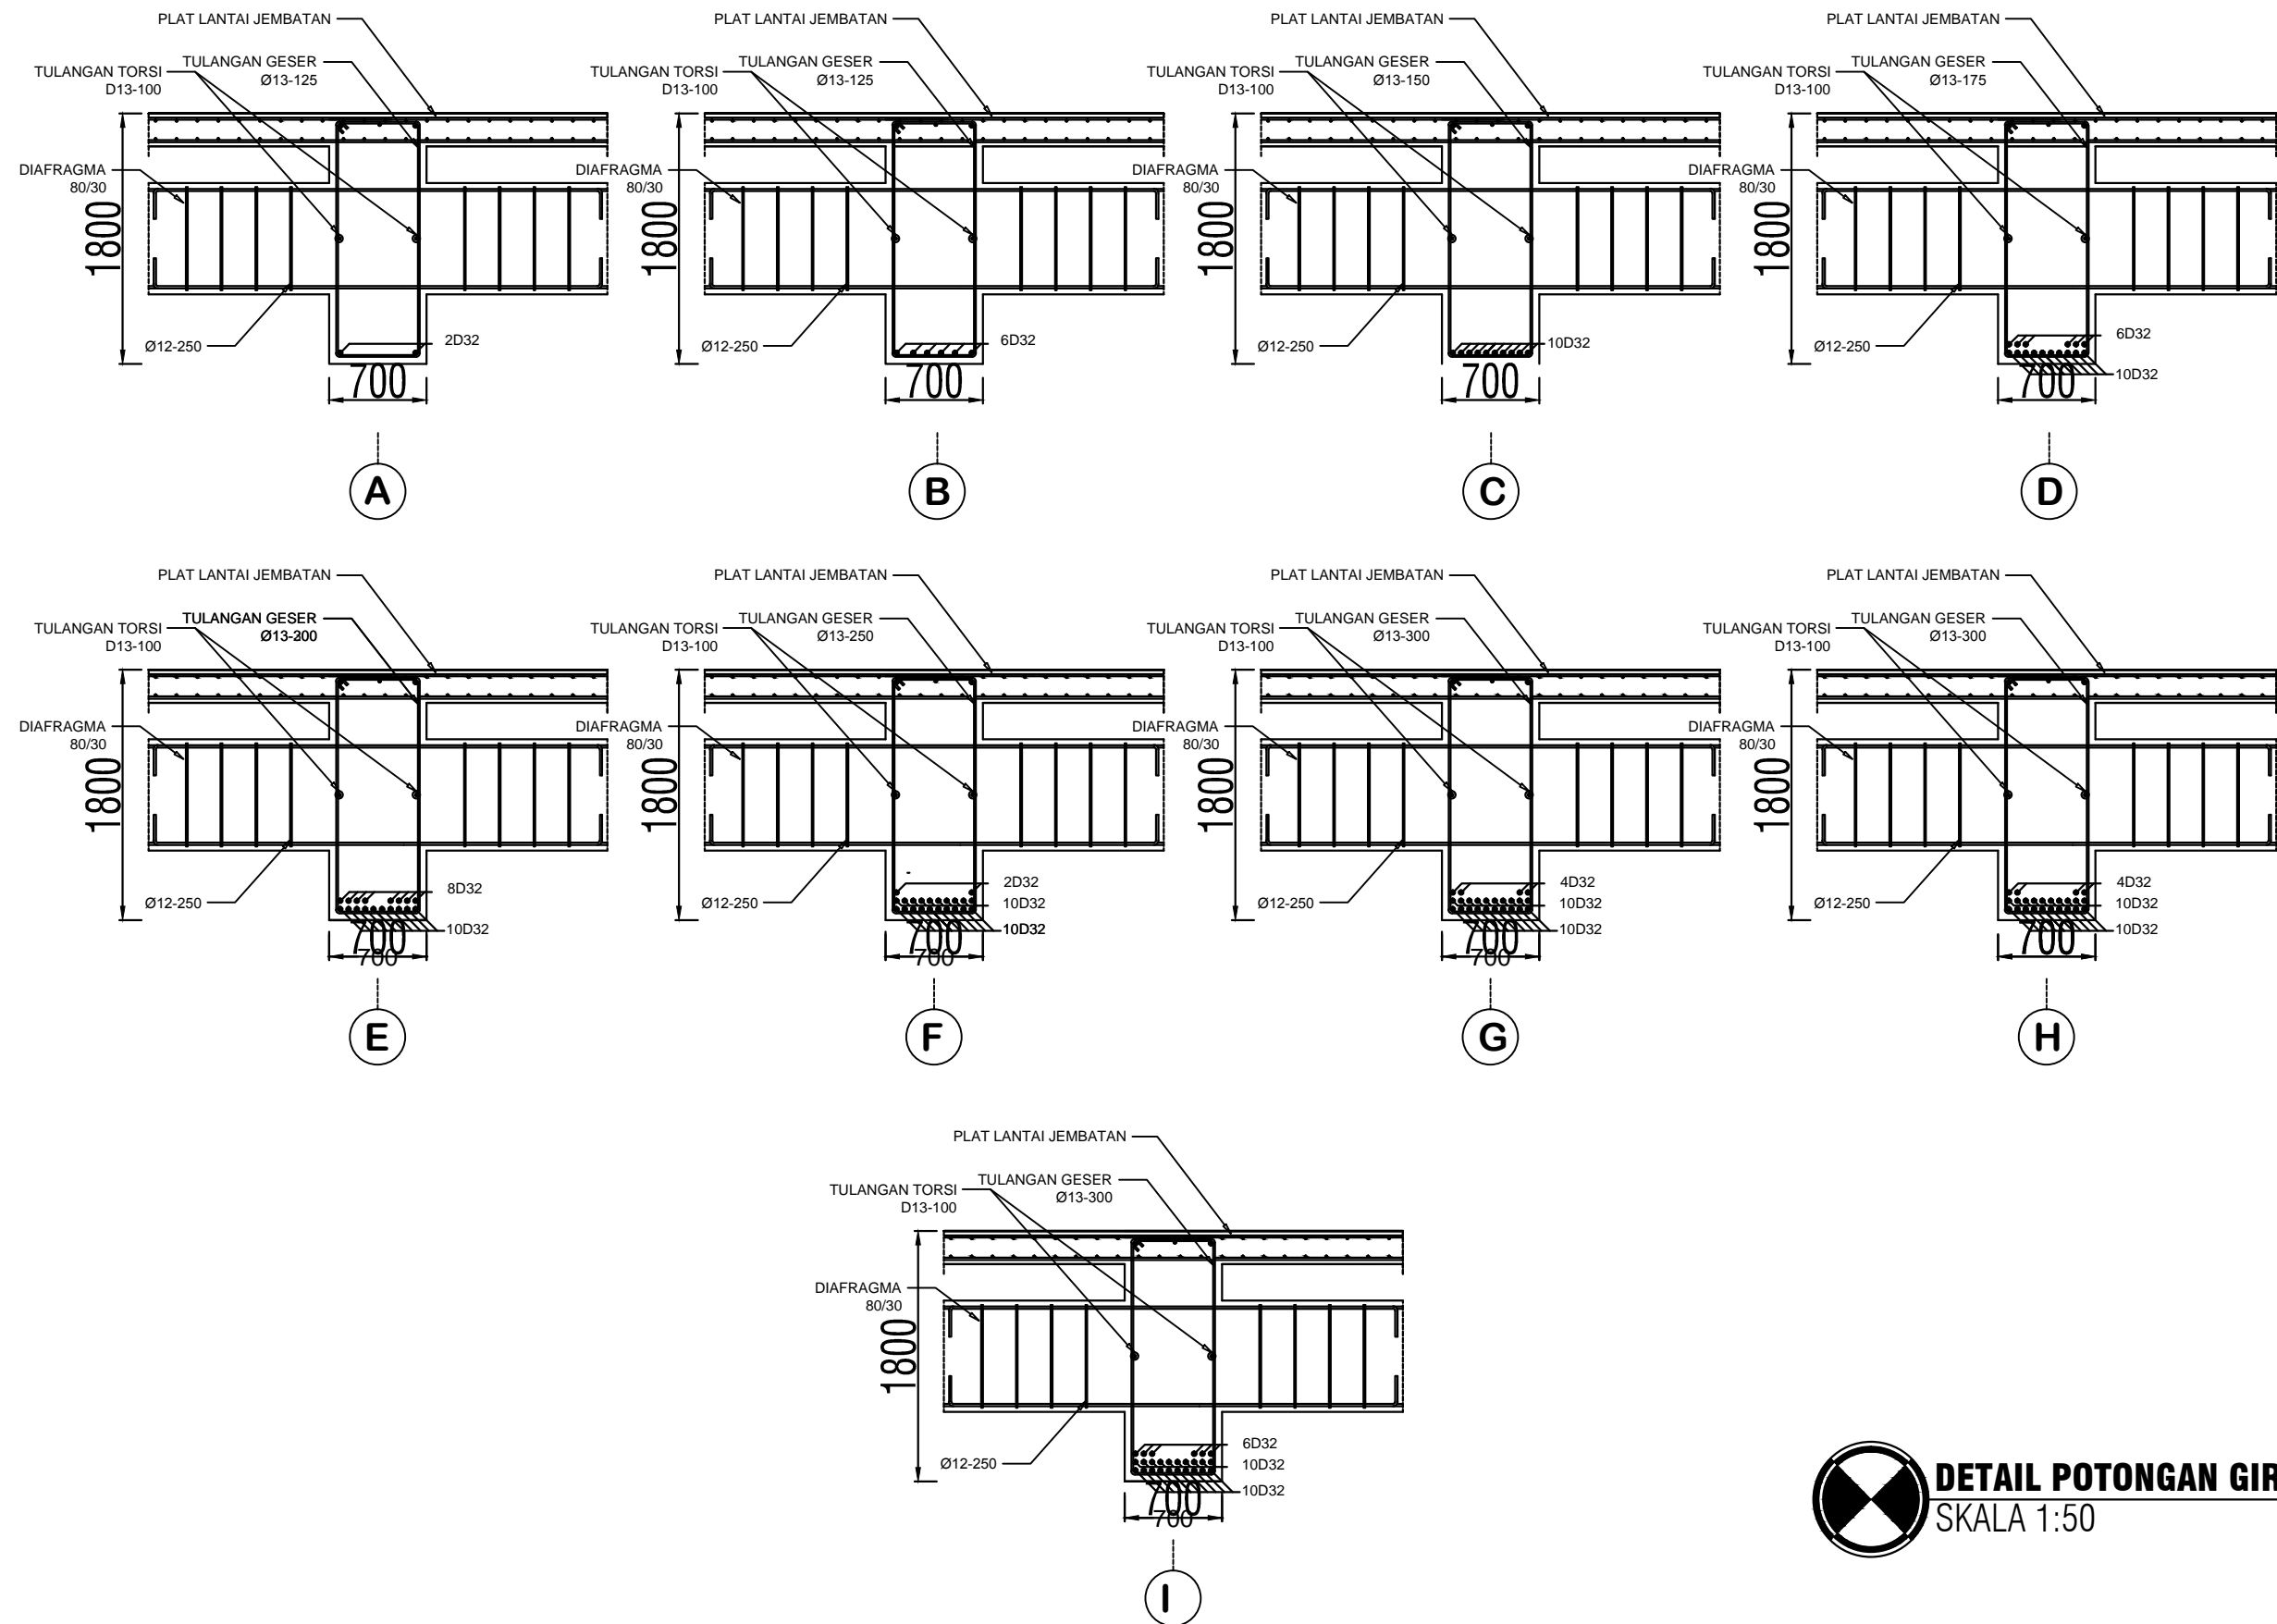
DETAIL PEMBAGIAN GIRDER BERDASARKAN JARAK SENGKANG
